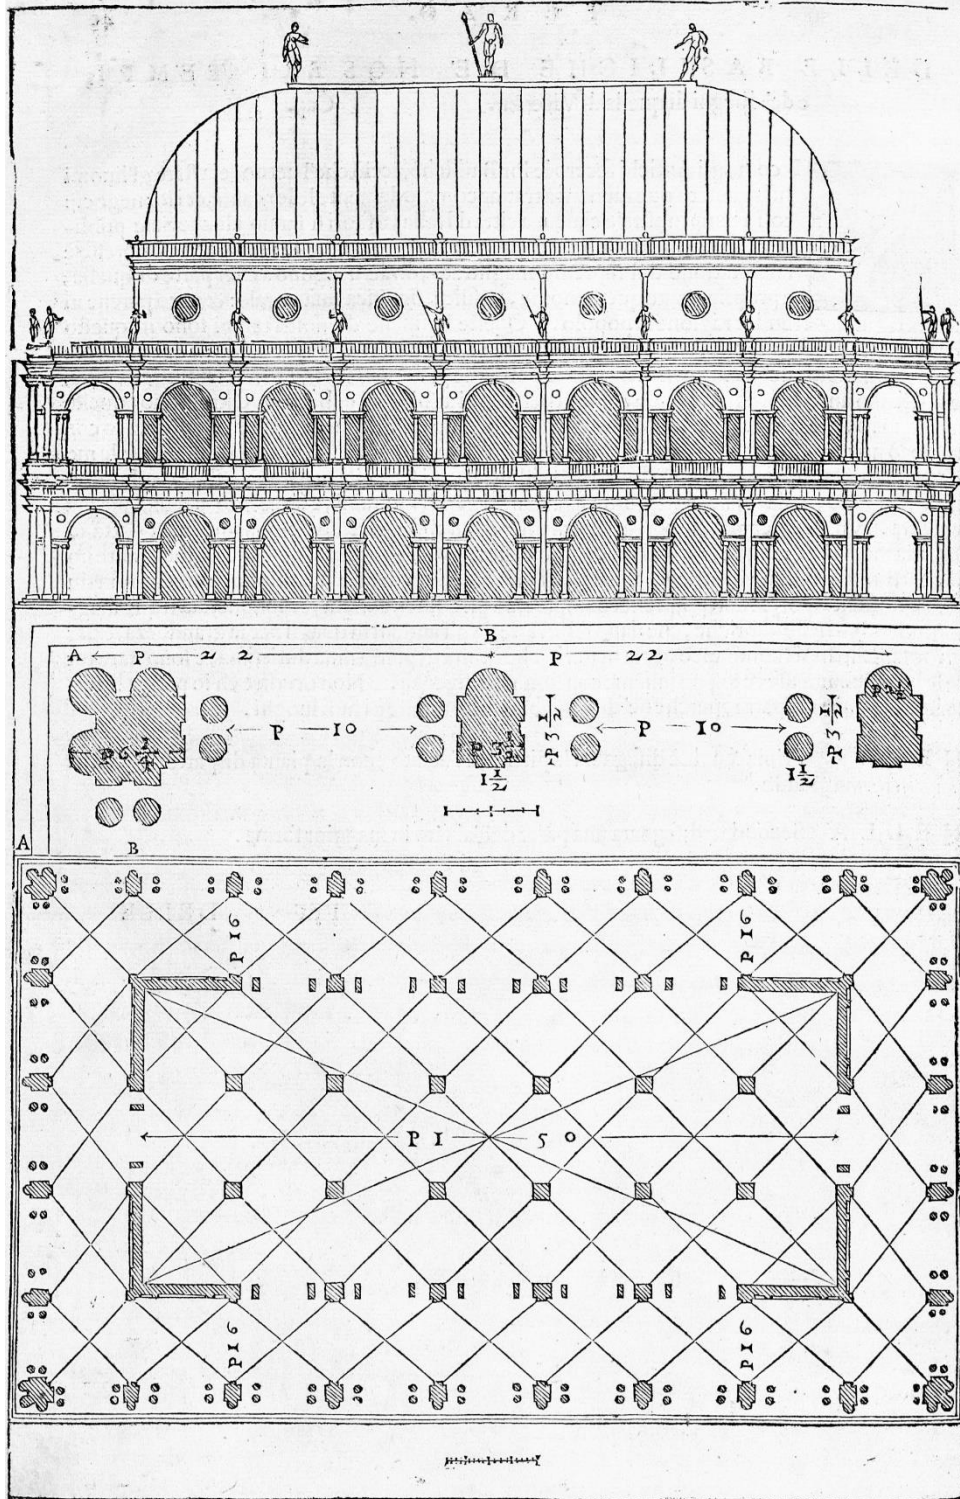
Andrea Palladio: *Palazzo della Ragione*, Aufriss/Grundriss, Vicenza, 1570
